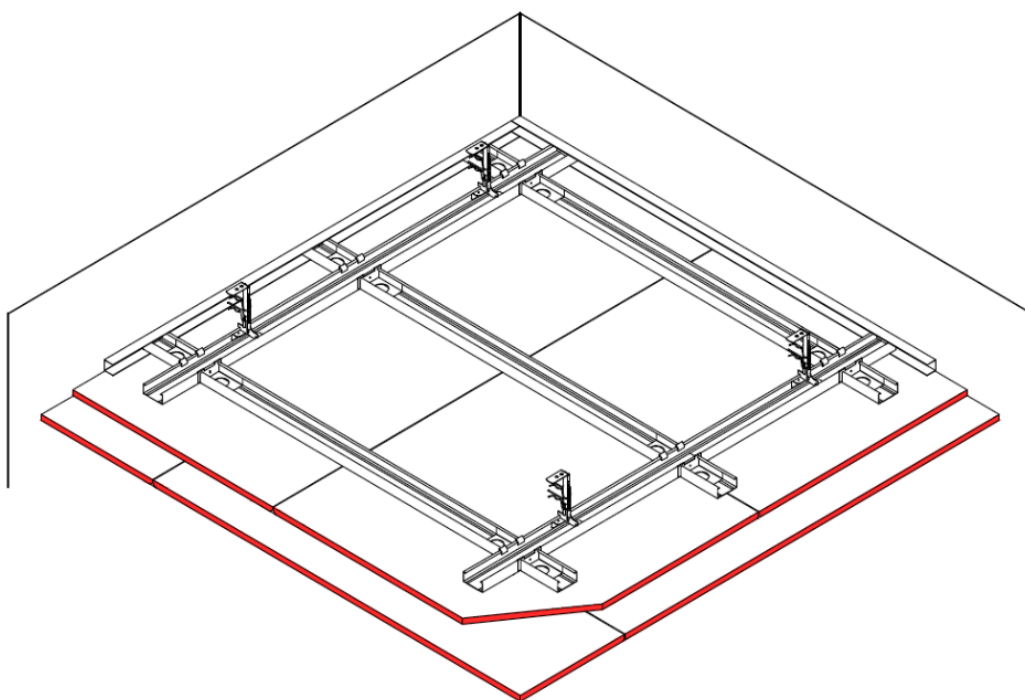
Unterdecke mit niveaugleicher Unterkonstruktion
